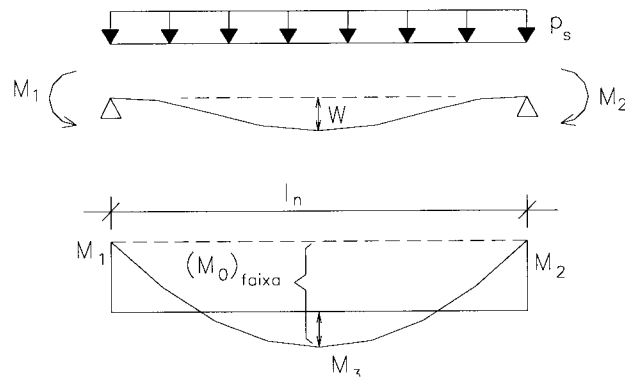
Esquema da viga para o cálculo do deslocamento [SCANLON e MURRAY, 1982]
